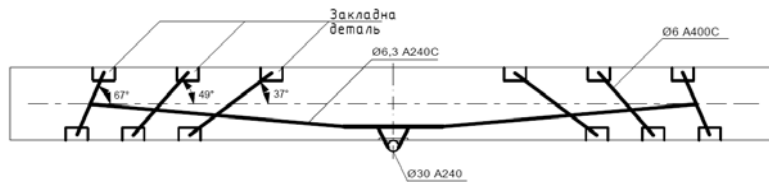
Схема підсилення балки БПС-II-1 поздовжньою і поперечною похило розташованою зовнішньою арматурою
